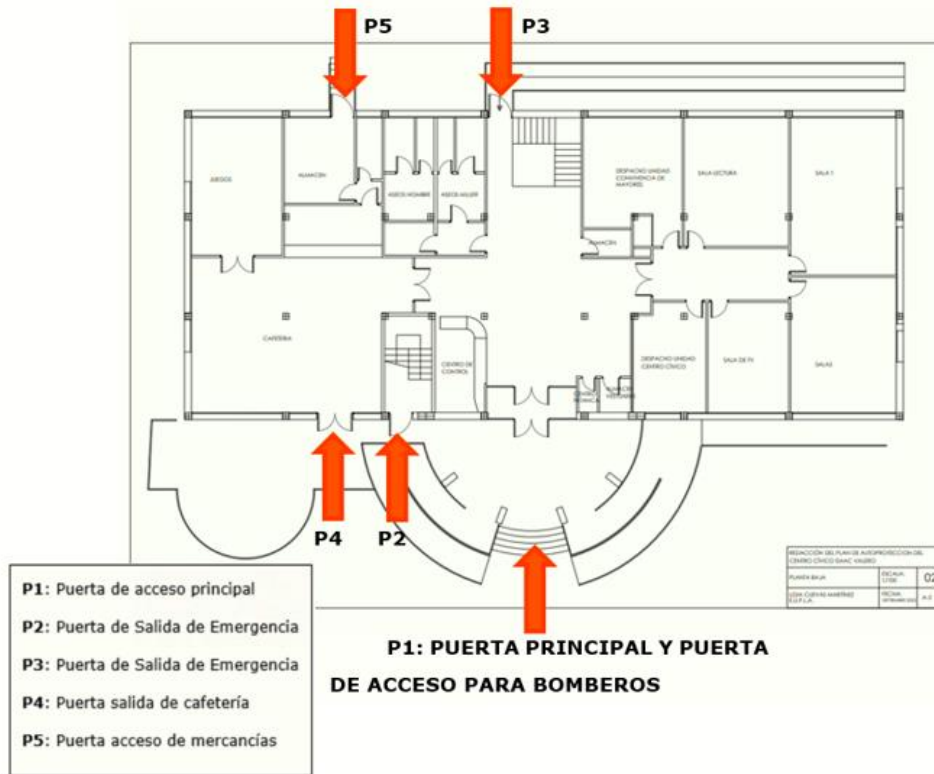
Plano ubicación puertas. Fuente: Elaboración Propia.
